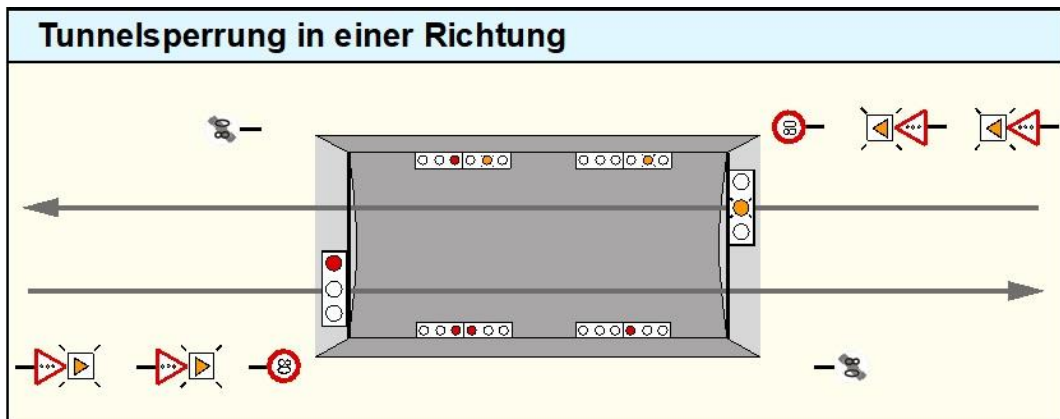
BZ – Tunnelsperrung in einer Richtung.
